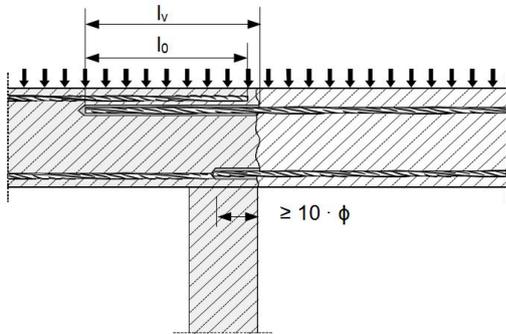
Übergreifungsstoß mit bestehender Bewehrung für Bewehrungsanschlüsse von Platten und Balken
